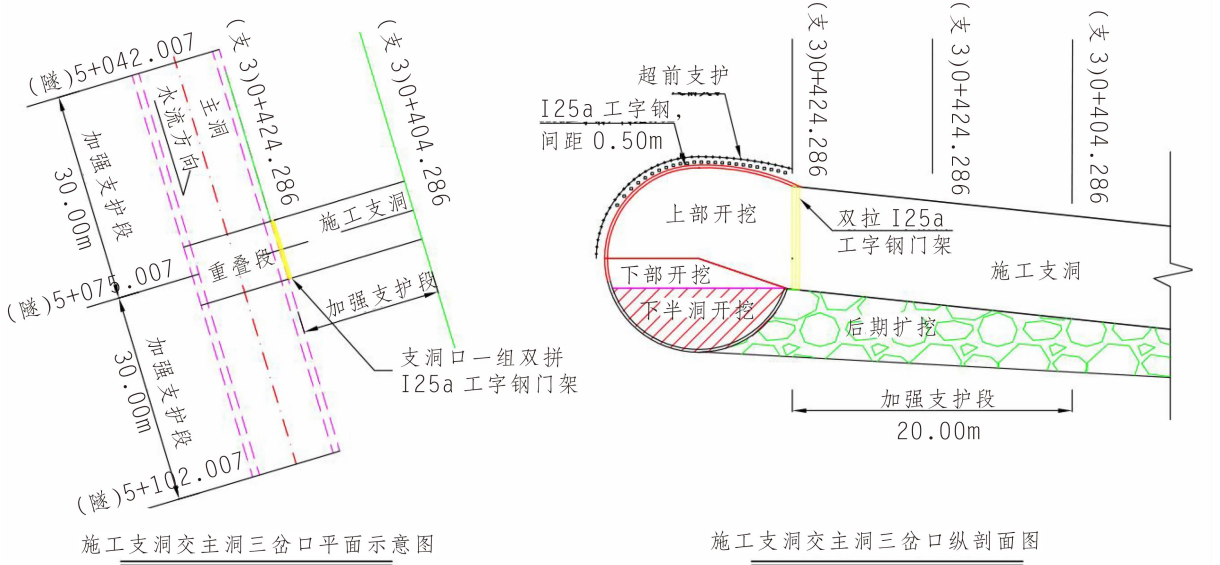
3号施工支洞交引水隧洞主洞三岔口处的施工布置图
